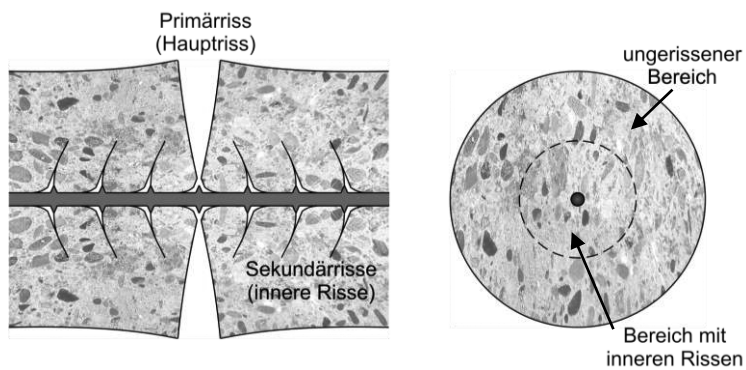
Betonverformung infolge Primäriss und Sekundärissen nach GOTO [60]
